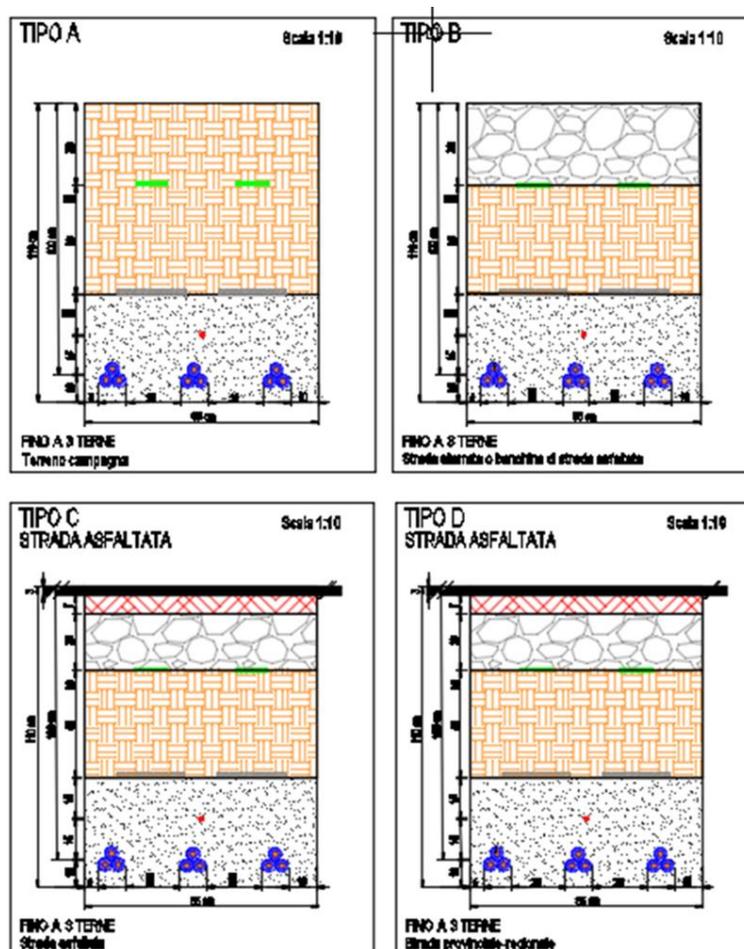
Sezione tipica di posa della linea in cavo su sede stradale per triplo cavidotto in MT
